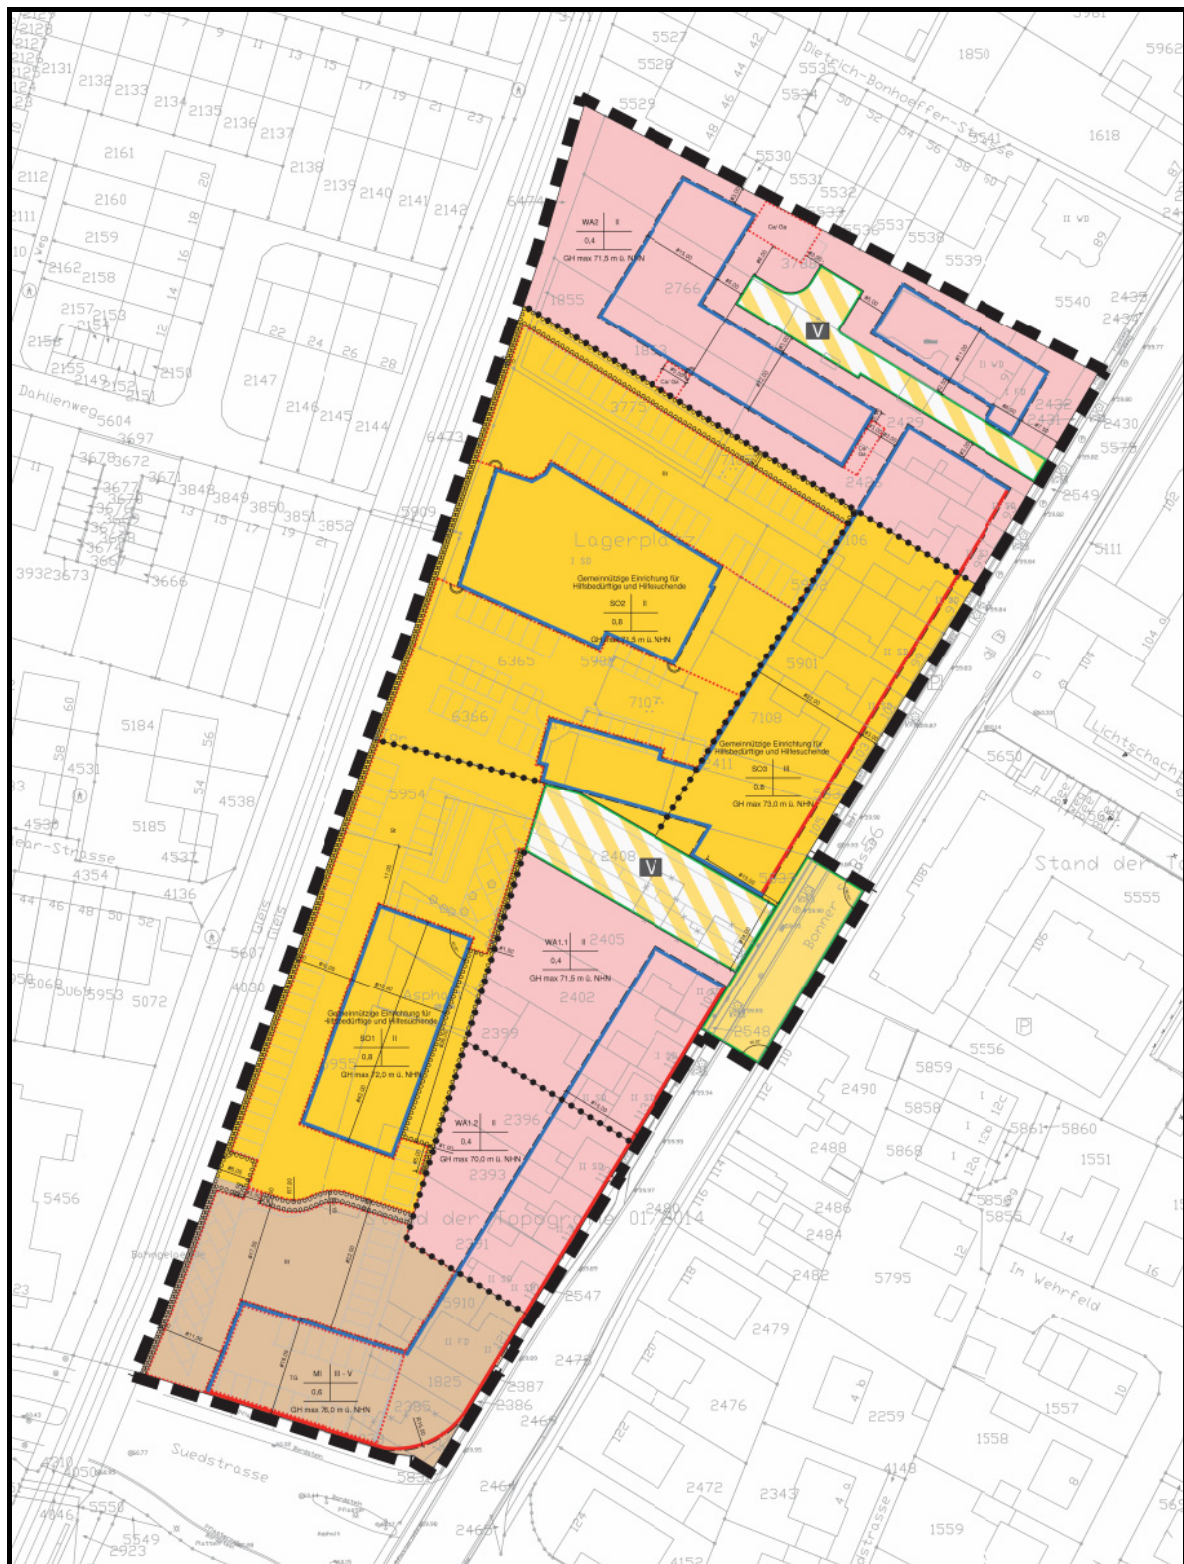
Entwurf des Bebauungsplans Nr. 516, 2. Änderung "Bonner Straße"
